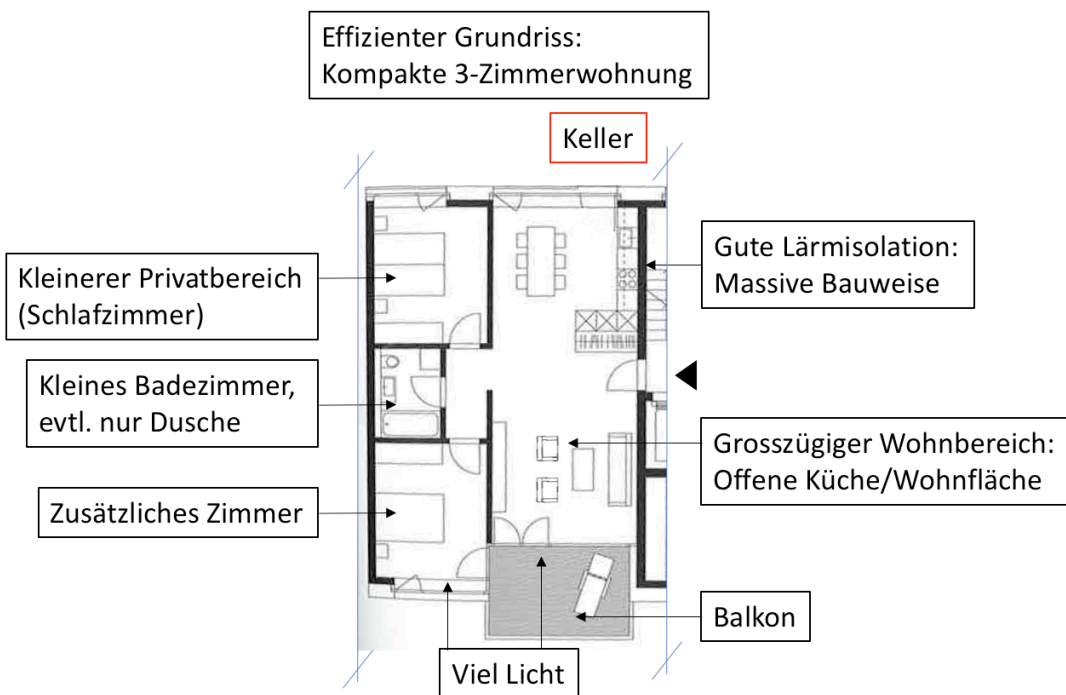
Dreizimmerwohnung. Beispiel für einen Grundriss (vgl. Hoskin, J., Reimer, T. 2011, S. 631)
